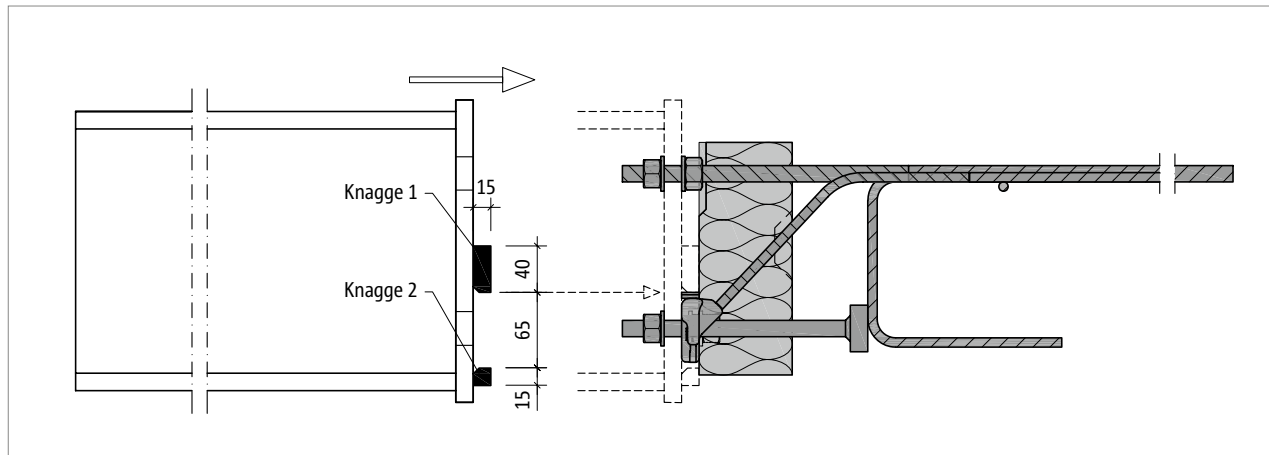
Schöck Isokorb® T Typ SKP: Montage des Stahlträgers
